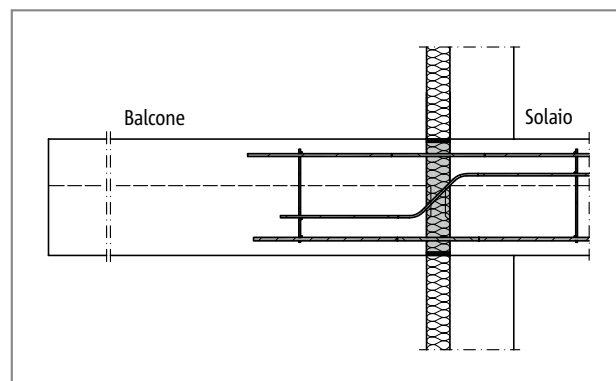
Schöck Isokorb® T tipo B: balcone con travi a sbalzo
